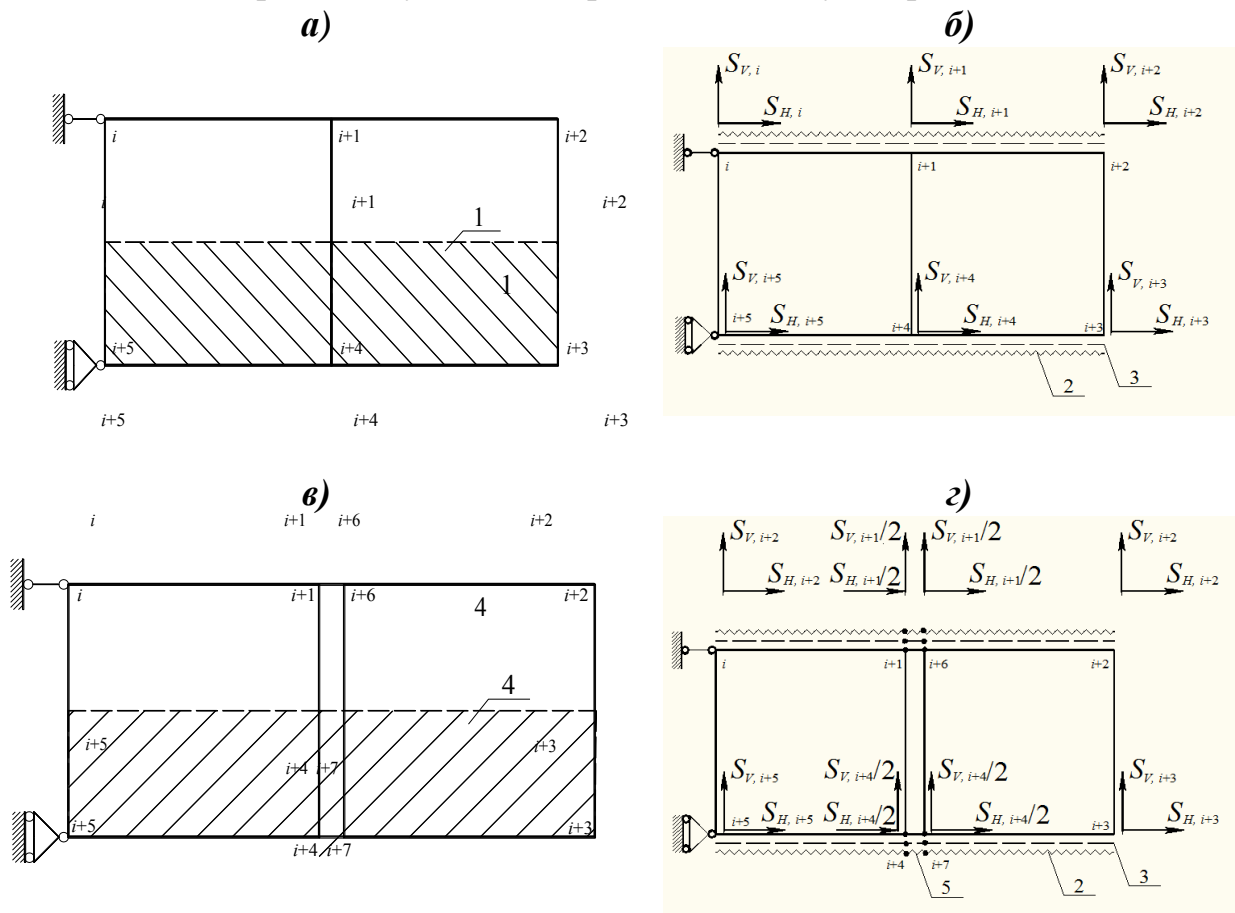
Построение двухэлементной модели: а – сбор нагрузки для 255 КЭ; б – расчетная схема двухэлементной модели без расшивки; в – сбор нагрузки для 255 КЭ, установленного в щели; з – расчетная схема двухэлементной модели с расшивкой; 1 – грузовая площадь 255 КЭ; 2 – 255 КЭ ($A_{b\ 255,1} = A_{b\ 255}/4$, где $A_{b\ 255}$ – площадь 255 КЭ в основной модели, $A_{b\ 255,1}$ – площадь 255 КЭ в двухэлементной модели); 3 – 201 КЭ ($A_{s\ 201,1} = A_{s\ 201}/2$, где $A_{s\ 201}$ – площадь 201 КЭ в основной модели, $A_{s\ 201,1}$ – площадь 201 КЭ в двухэлементной модели); 4 – грузовая площадь 255 КЭ; 5 – 255 КЭ ($A_{b\ 255,2} = A_{b\ 255}/2$, где $A_{b\ 255}$ – площадь 255 КЭ в основной модели, $A_{b\ 255,2}$ – площадь 255 КЭ в двухэлементной модели)
